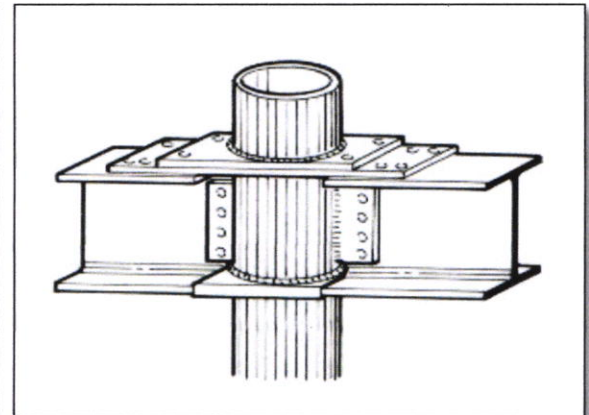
jonction poteau-poutre I ; source : auteurs 2018.
